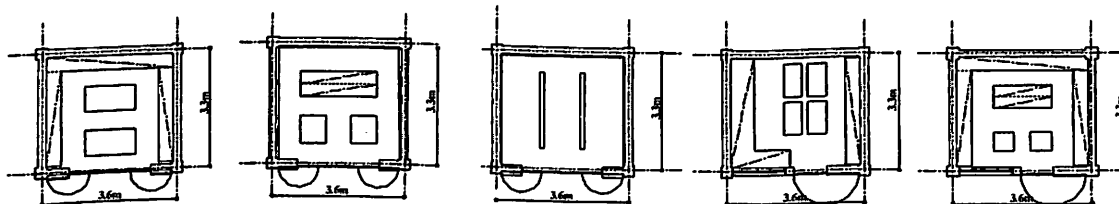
Exemple de disposition de stand de vente ($3,6$ m \times $3,3$ m)
